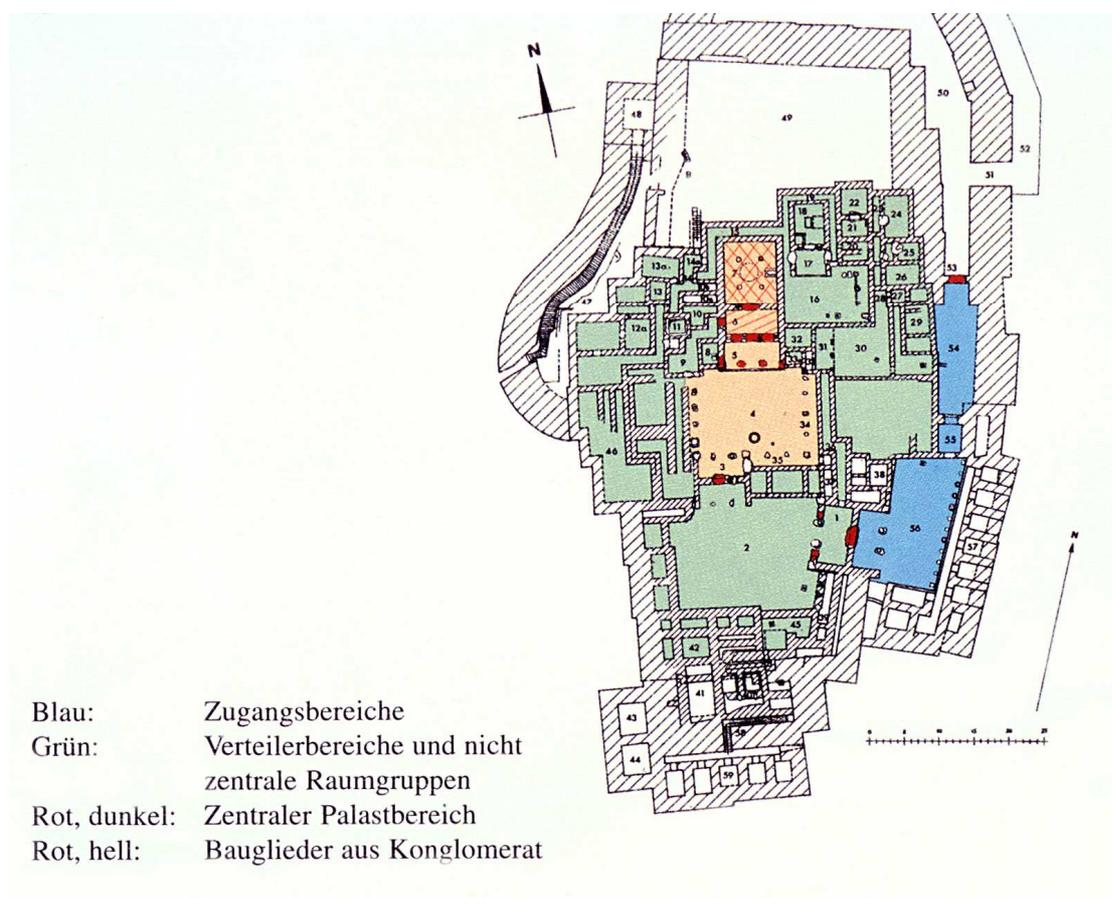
Tiryns, Grundrissplan nach M. Küpper.
